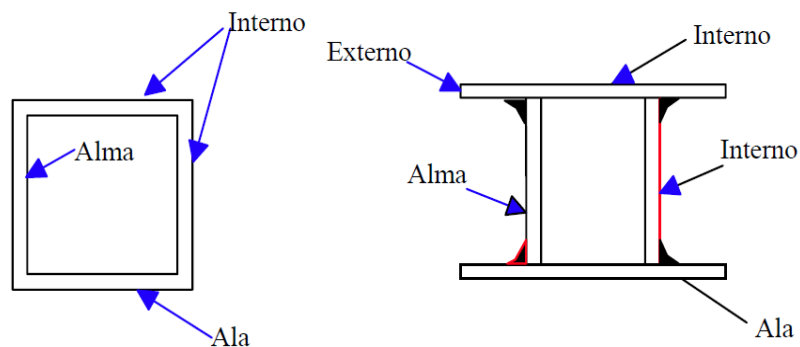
Secciones Huecas Laminada (izq.) y Soldada (der.)
